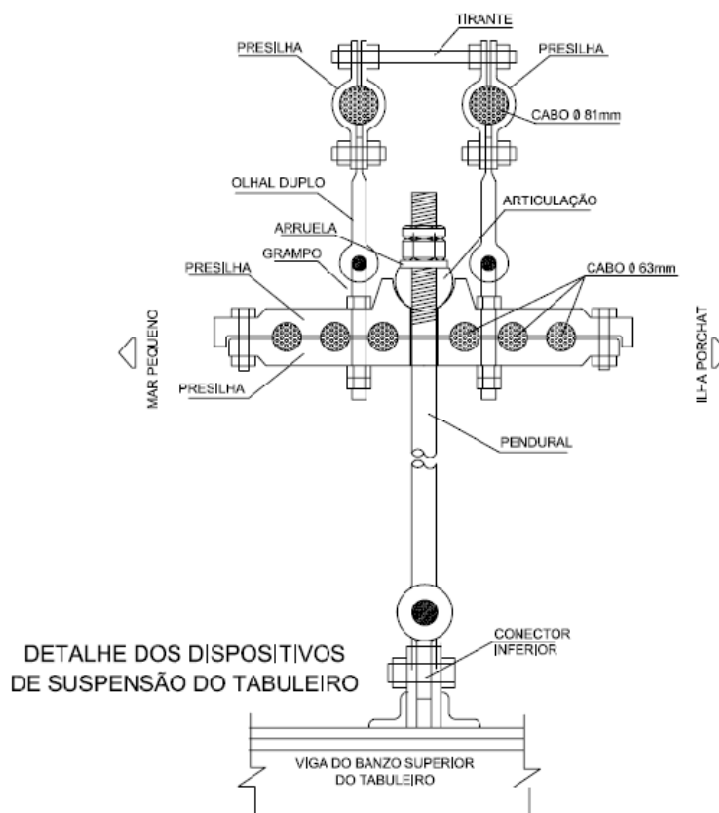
Detalhe das presilhas de suspensão do tabuleiro
